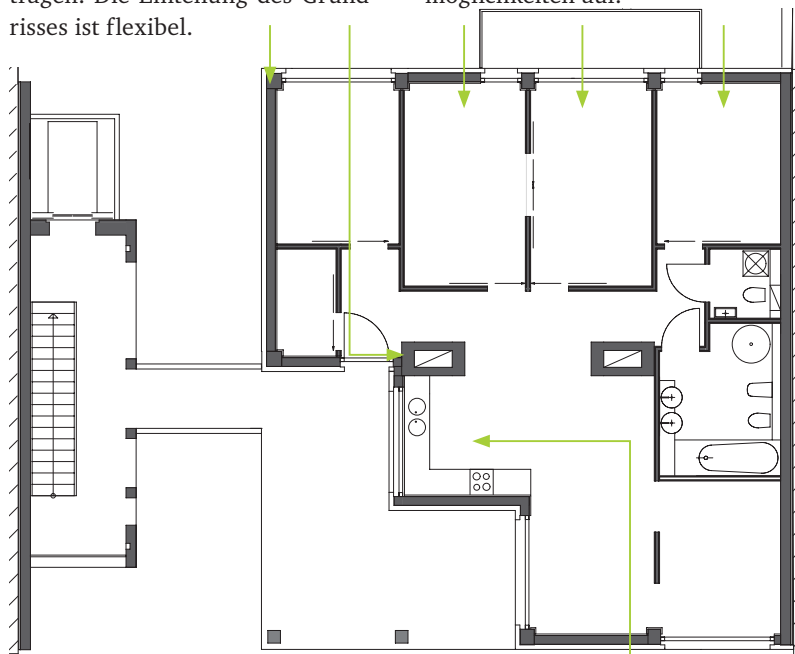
Grundriss 1. OG o. M., Grafik: Büro Klingbeil + Kaden
